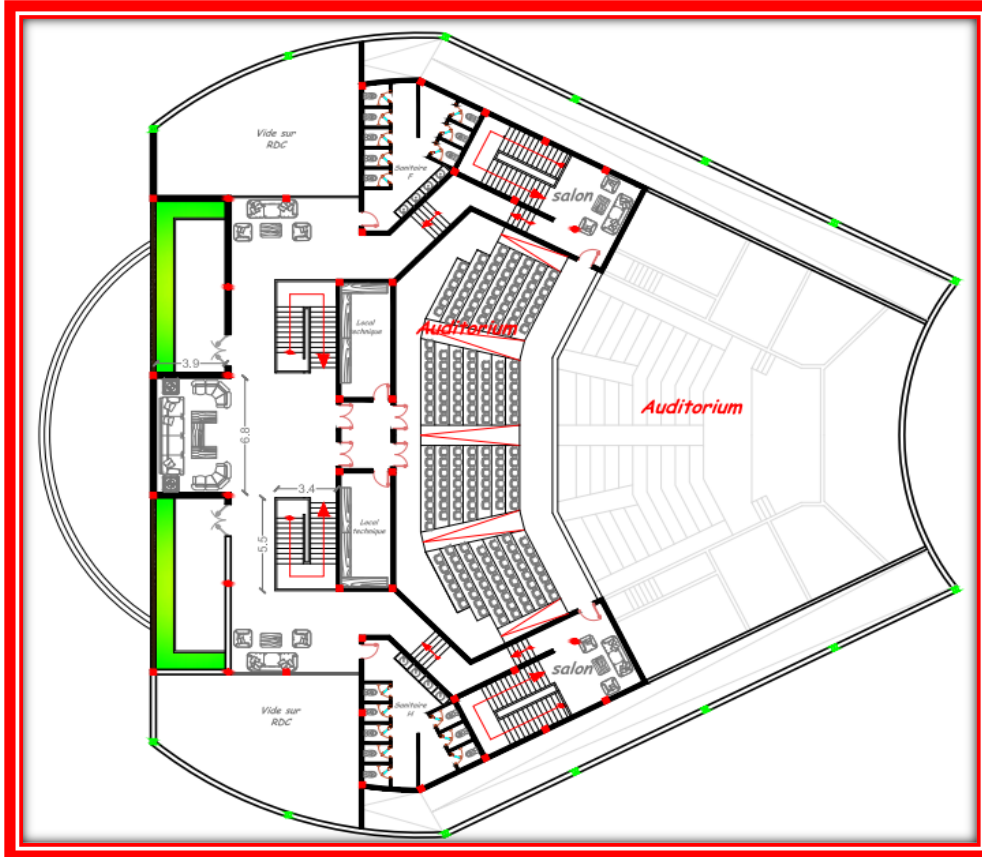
Le plan de niveau 2 (l'auditorium) / source : auteur
